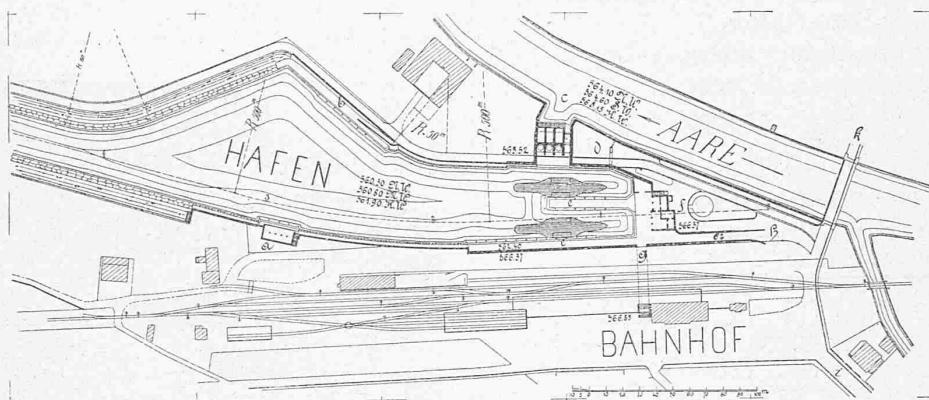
Lageplan der Hafenanlage in Interlaken. 1:4000.
